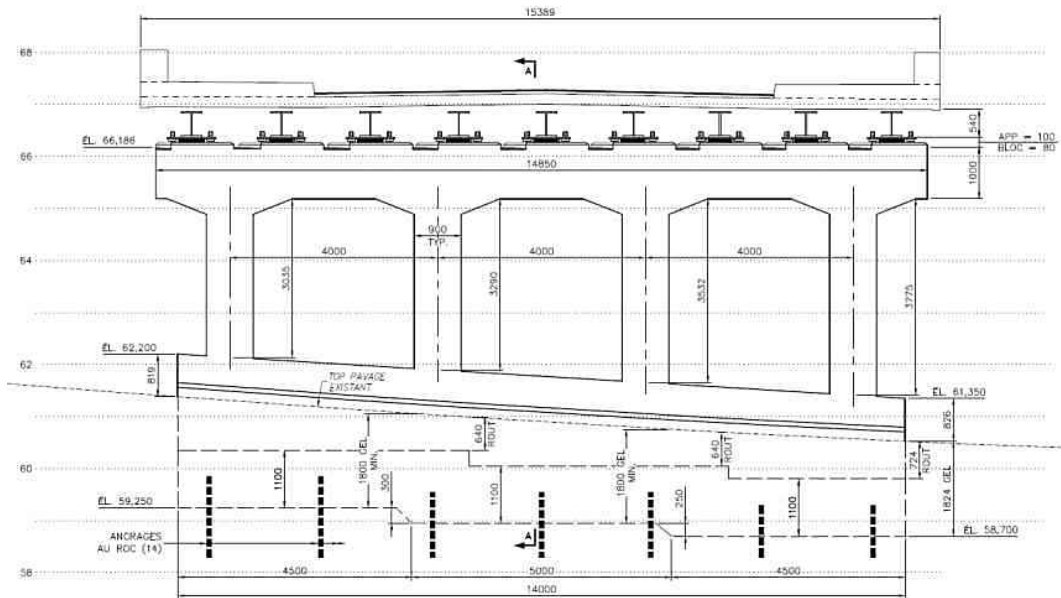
Pont d'étagement routier – Pile axe 2 – Variante A - Vue en élévation
